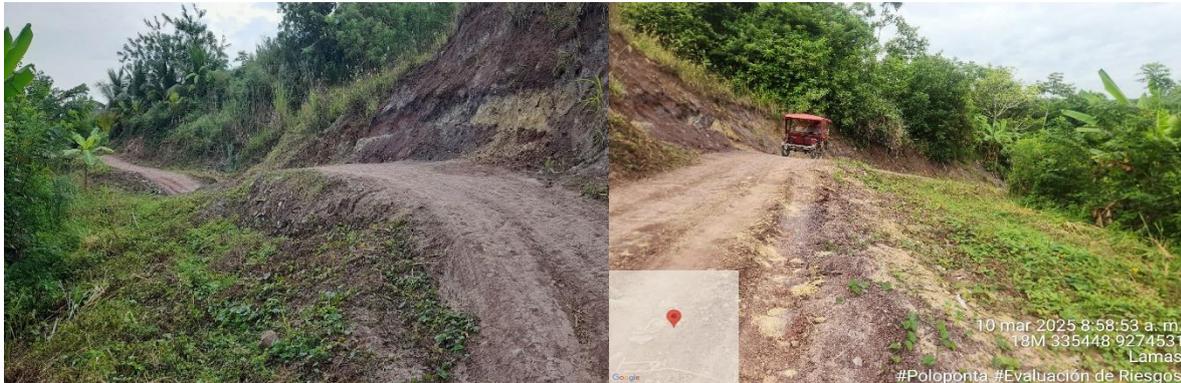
En colindancia con la quebrada de Zapaterillo, se tiene estas fisuras un poco profundas siendo en su mayoría compuestas de areniscas y gravas (coluivialuvial)
